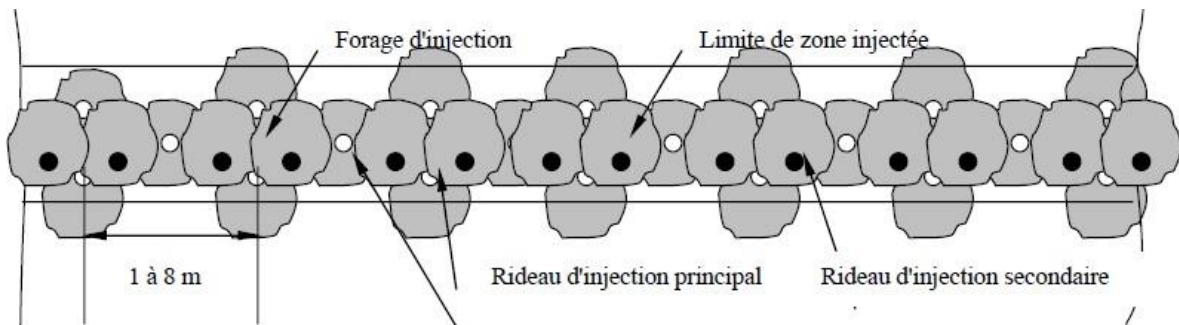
Vue en plan de la disposition d'un rideau d'injection
